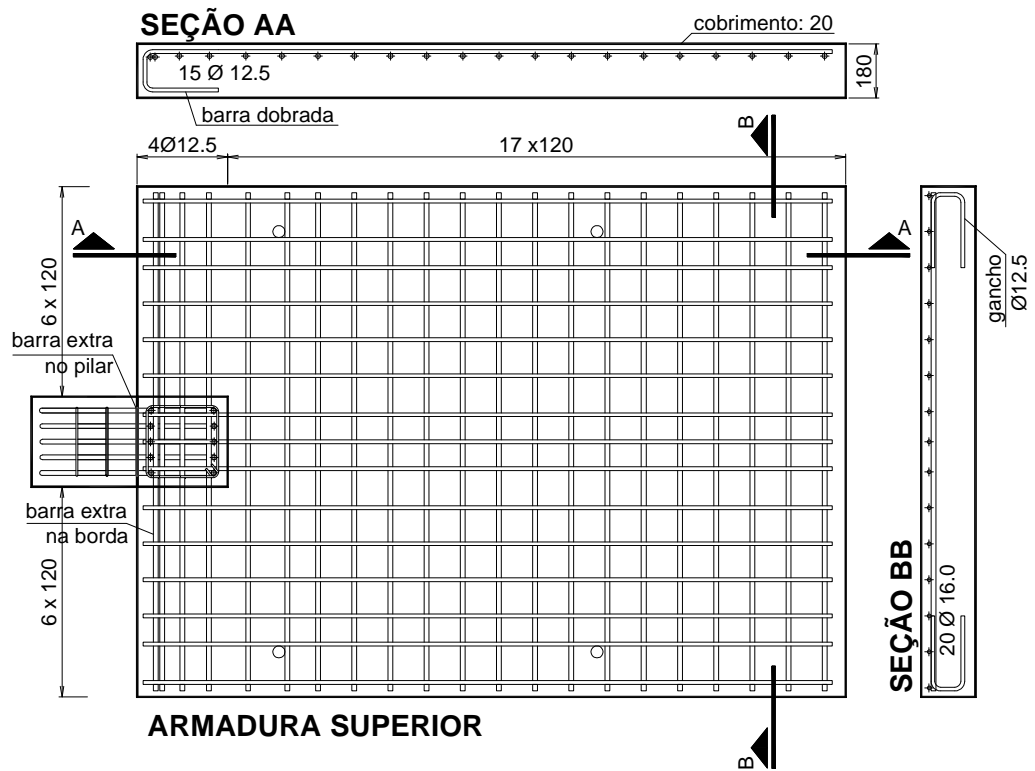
Modificação da distribuição da armadura superior e pilar (L7-L8, L10-L13)
